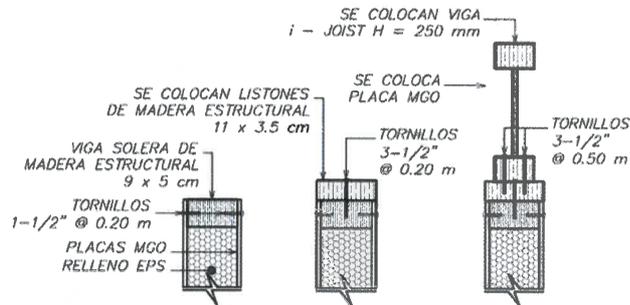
Detalle conexión vigas soleras - vigas inferiores (vista en planta).
